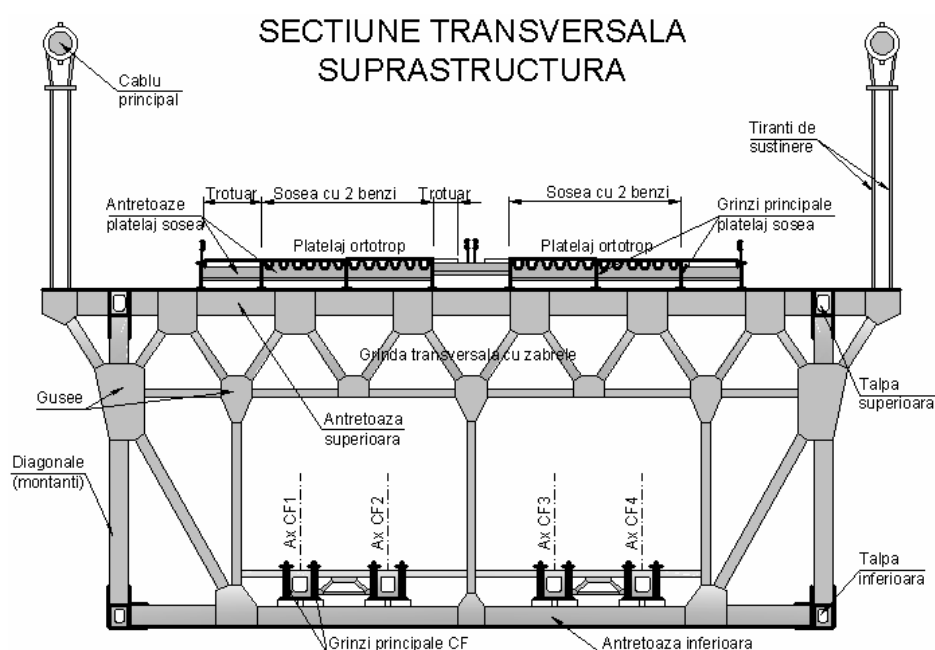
Secțiune transversală a podului suspendat combinat Minami Bisan-seto
